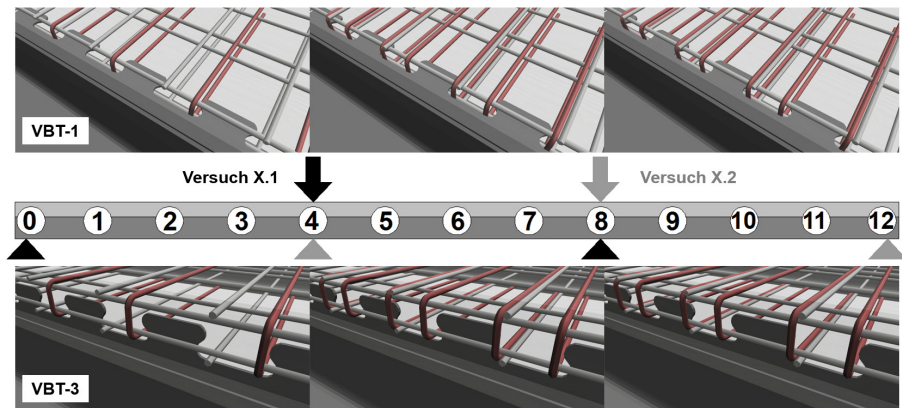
Detailansicht der Bewehrungsführung bei VBT-1 und VBT-3 über die Trägerlänge
